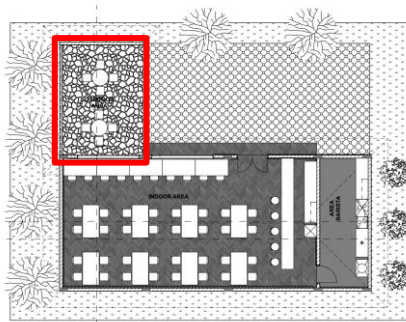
Denah Zona 2 Redesign Pier Coffee
